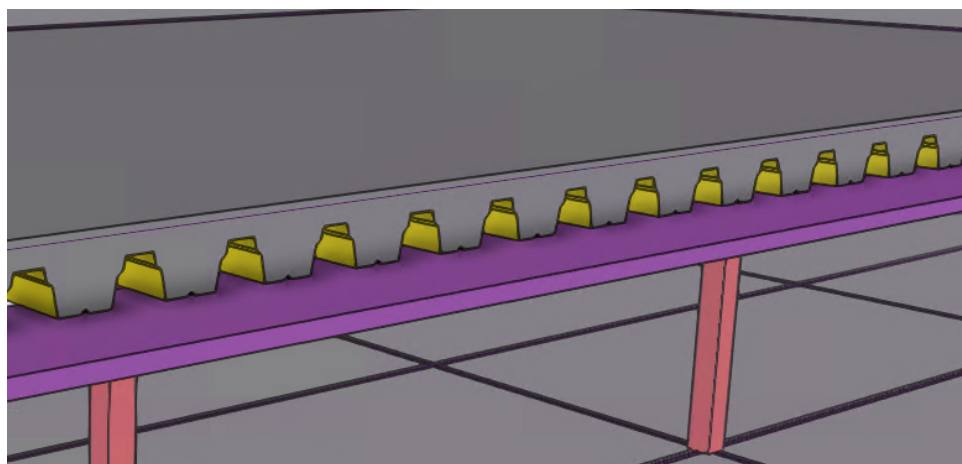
Сечение сталежелезобетонного перекрытия (стержневая арматура условно не показана)
